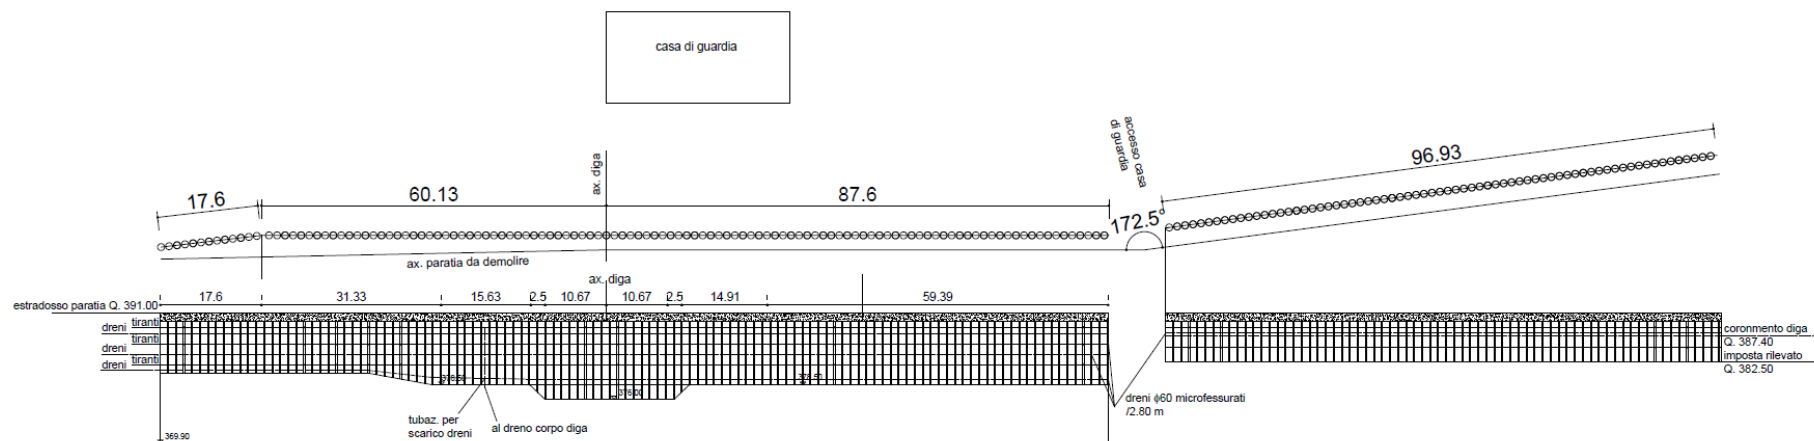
Planimetria e prospetto della paratia in sponda destra (P1).
